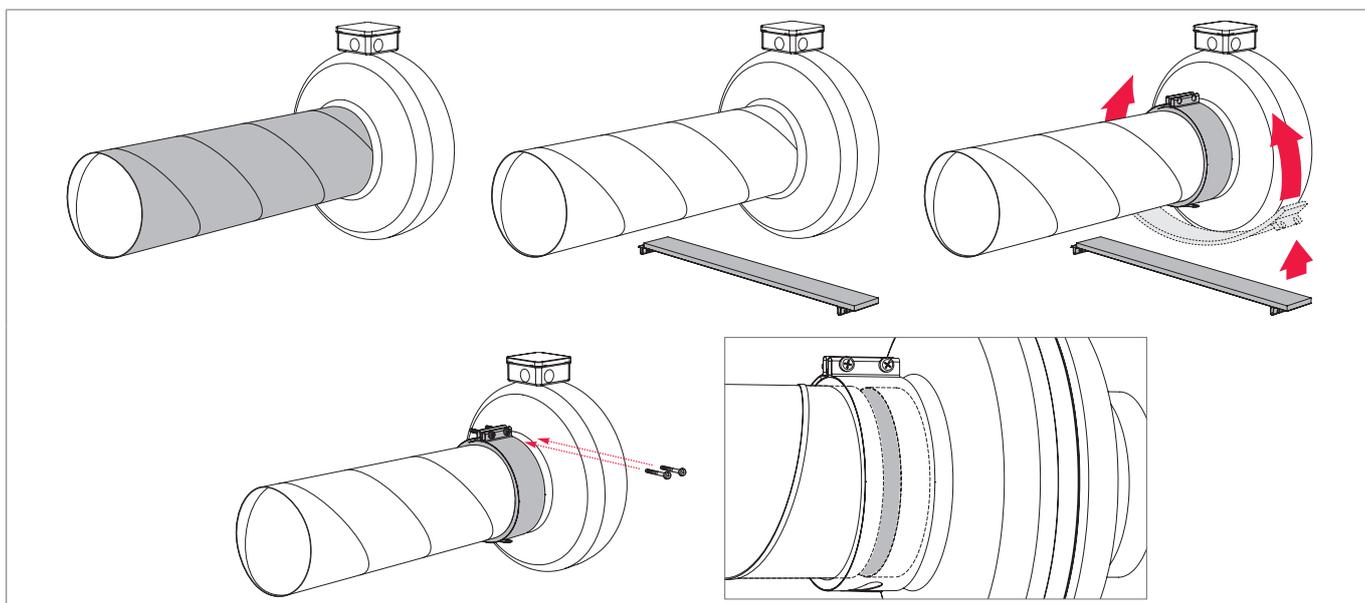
Connexion au conduit d'air à l'aide d'une manchette
